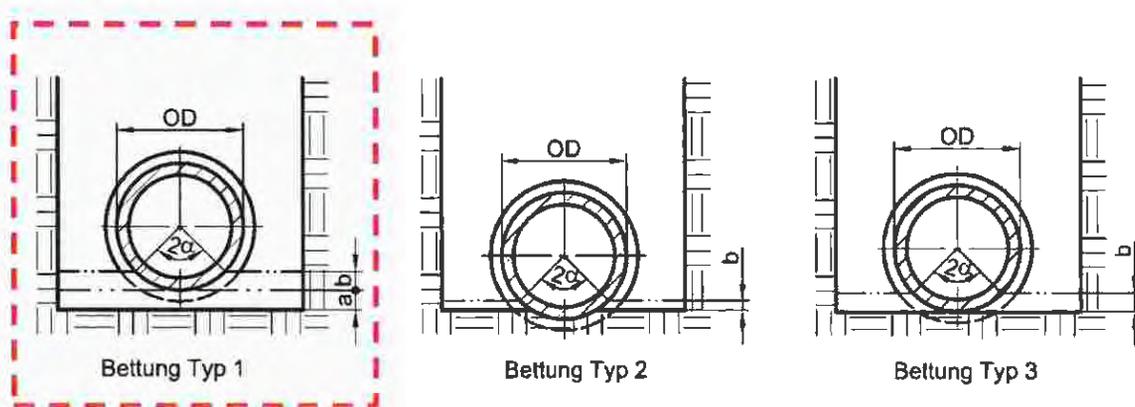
Prinzipskizze der Bettungstypen nach DIN 1610 (siehe Norm für das Kanalnetz, Berliner Wasserbetriebe, Regelblatt 15, Bild 2). Rot umrandet: durchzuführende Bettung im Untersuchungsgebiet.
